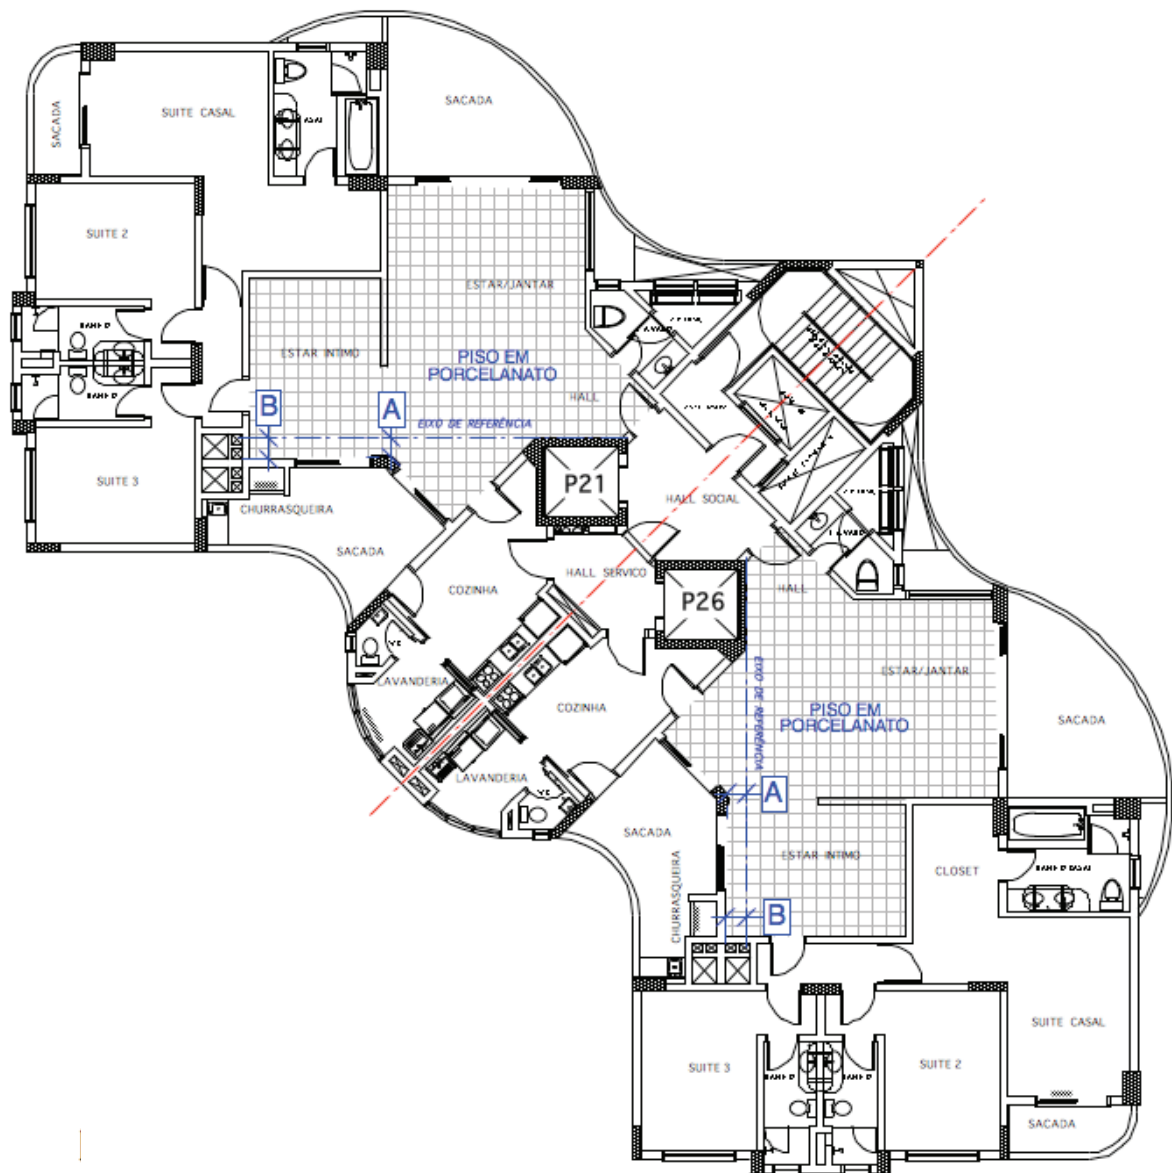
Planta Baixa do Pavimento Tipo com Pontos de Controle de conferência do esquadro interno – sem escala.
